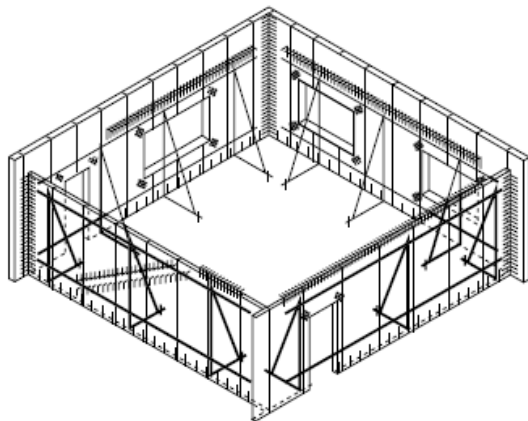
5. Colocación de mallazos planos y angulares de refuerzo
